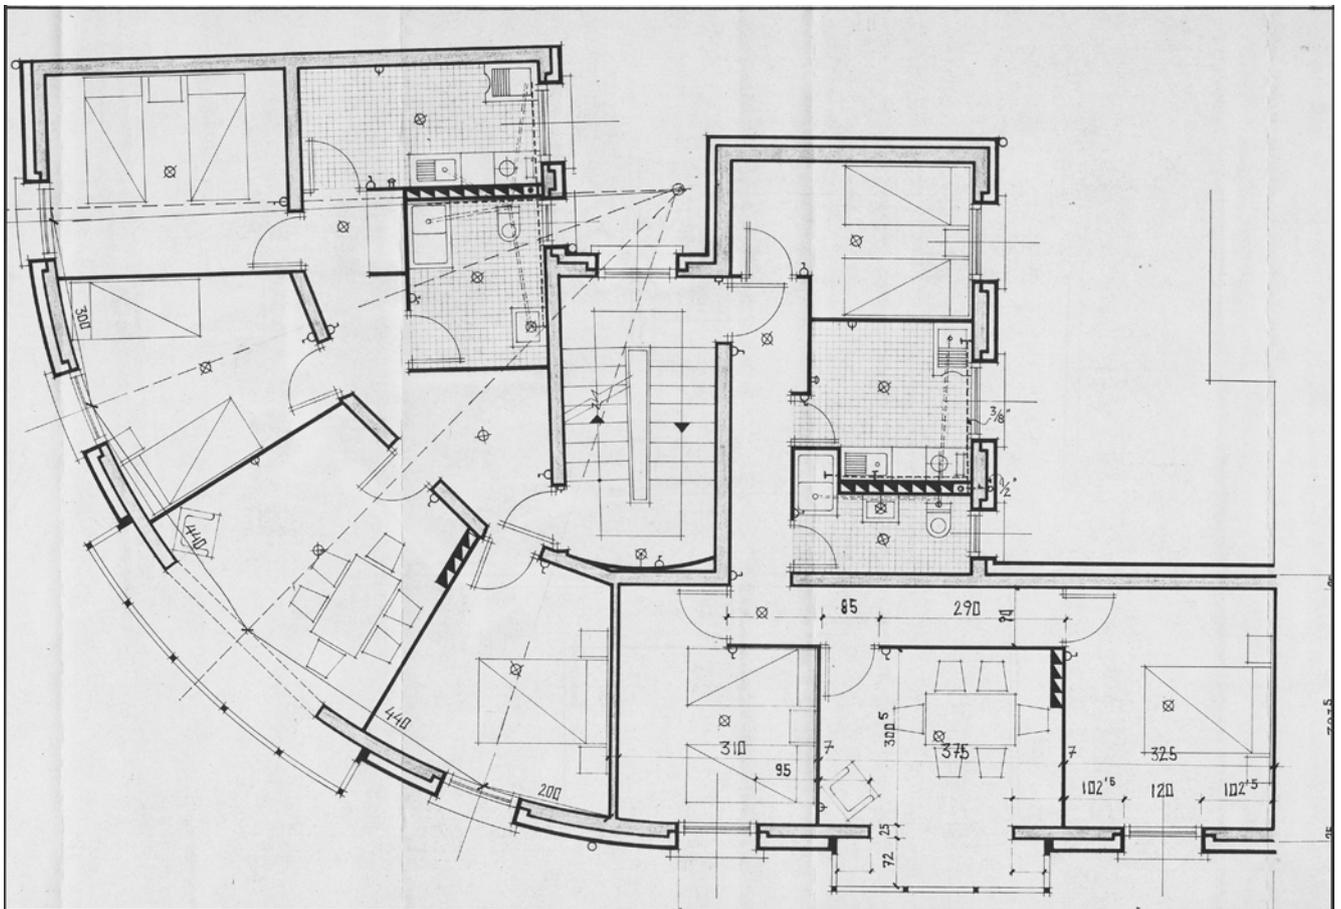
Pormenor del Plano N° 20. Planta de pisos: Viviendas tipo C y D, abril 1956.
